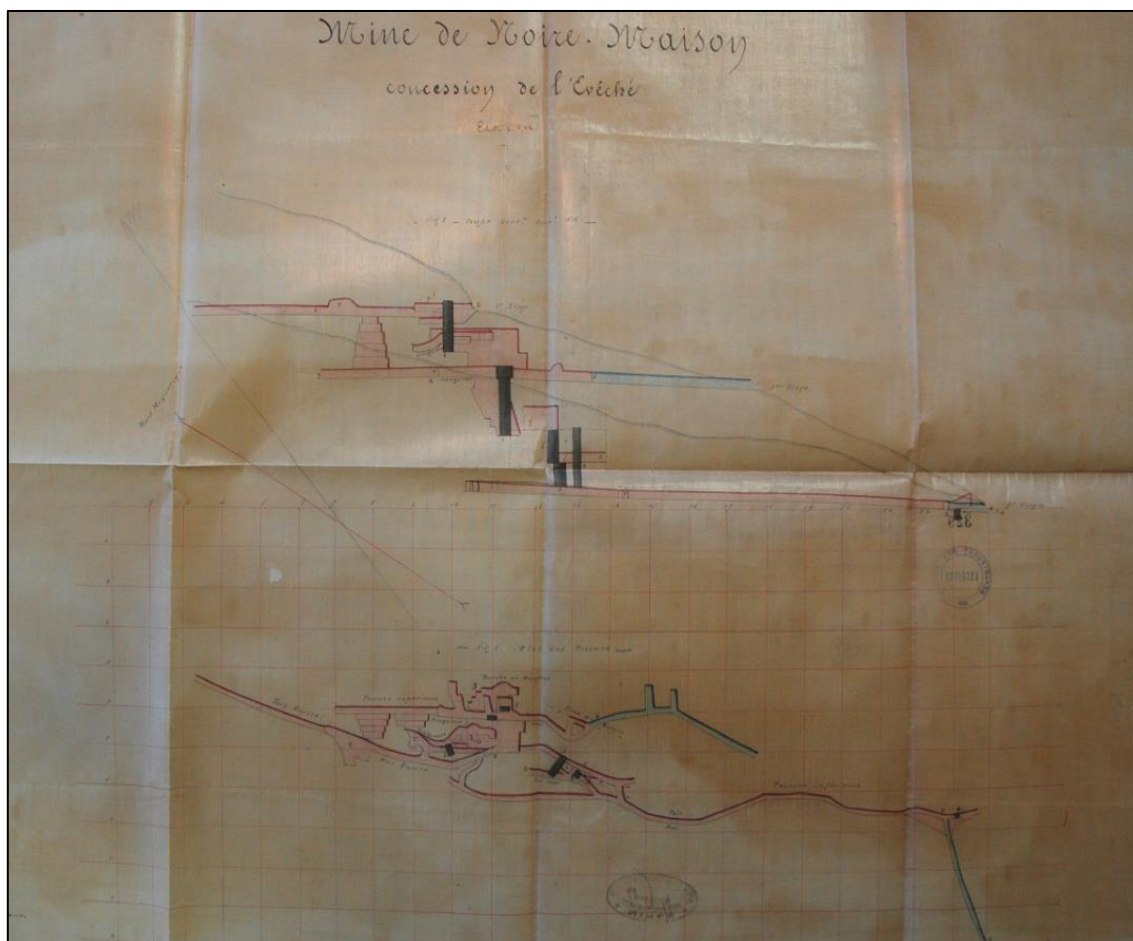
Plan et coupe de la Mine de Noire-Maison - 1859
